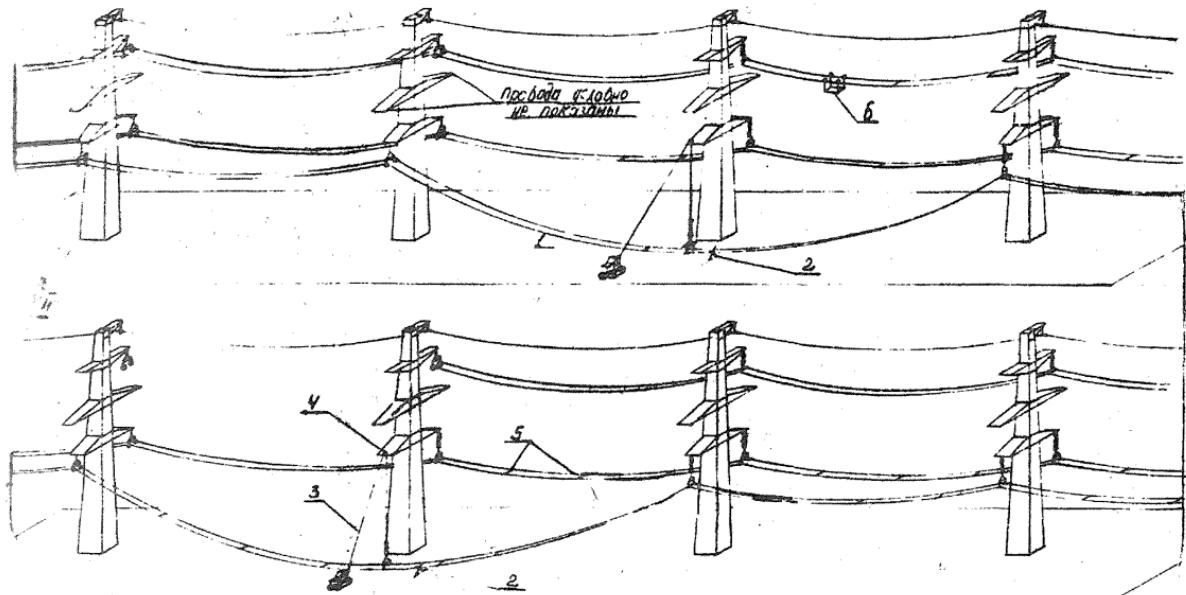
Установка дистанционных распорок при перекладке проводов на земле
